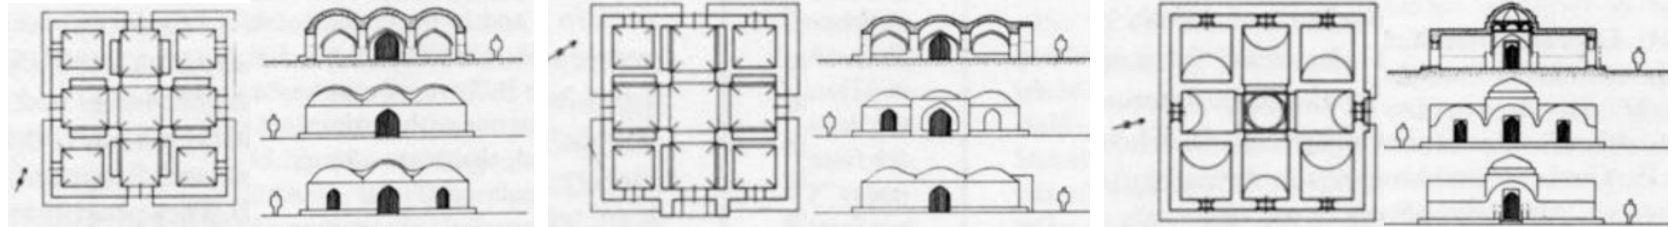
Plantas y secciones de tres caravasares-pabellón.
